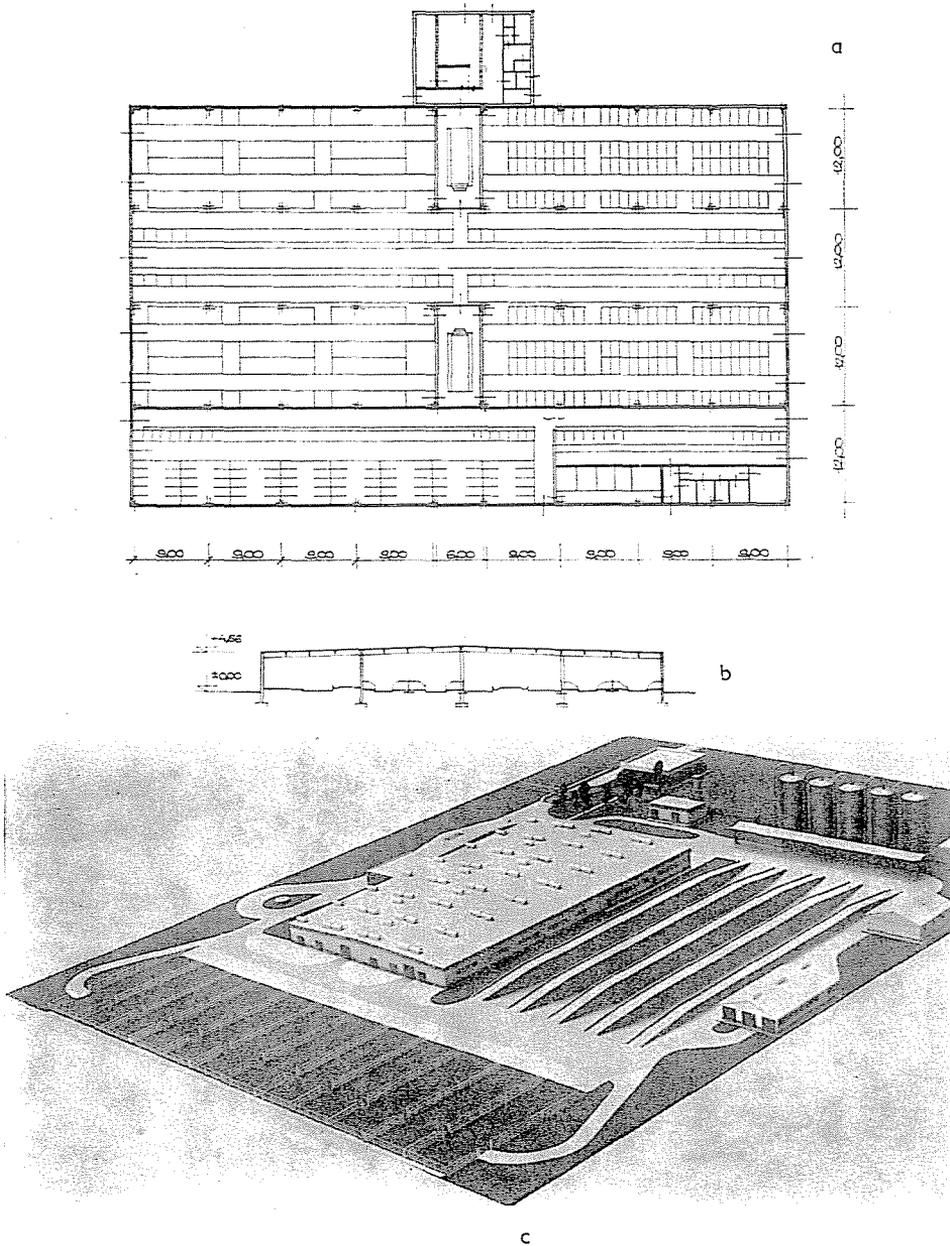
Milchviehanlage mit geschlossenen Ställen mit Liegeboxen in Környe: a — Grundriß; b — Querschnitt; c — Fernansicht
